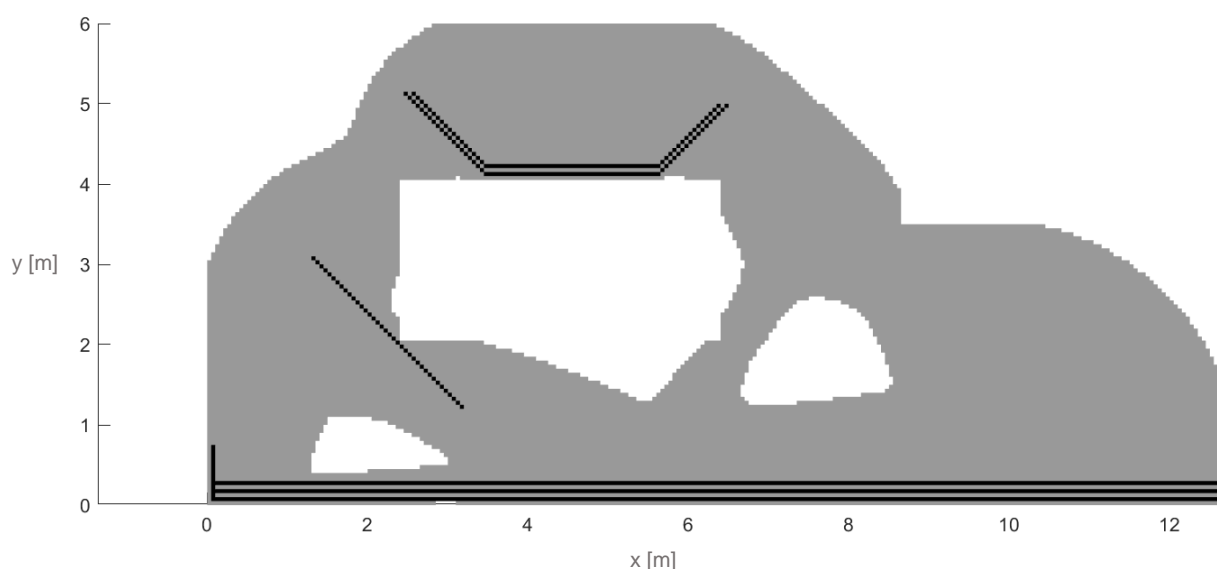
Estrutura otimizada com armaduras proposta para verificação.
